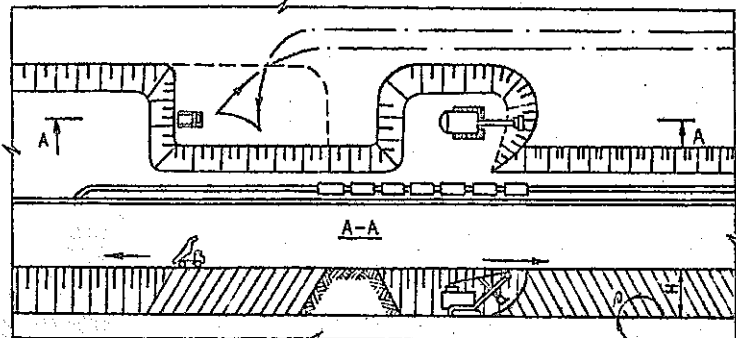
Схема отсыпки штабеля поперечным фронтом
